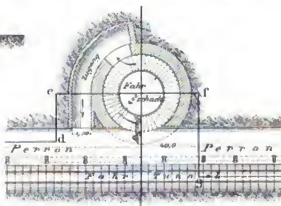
Grundriss einer eingelegigten Schleifenstation.
